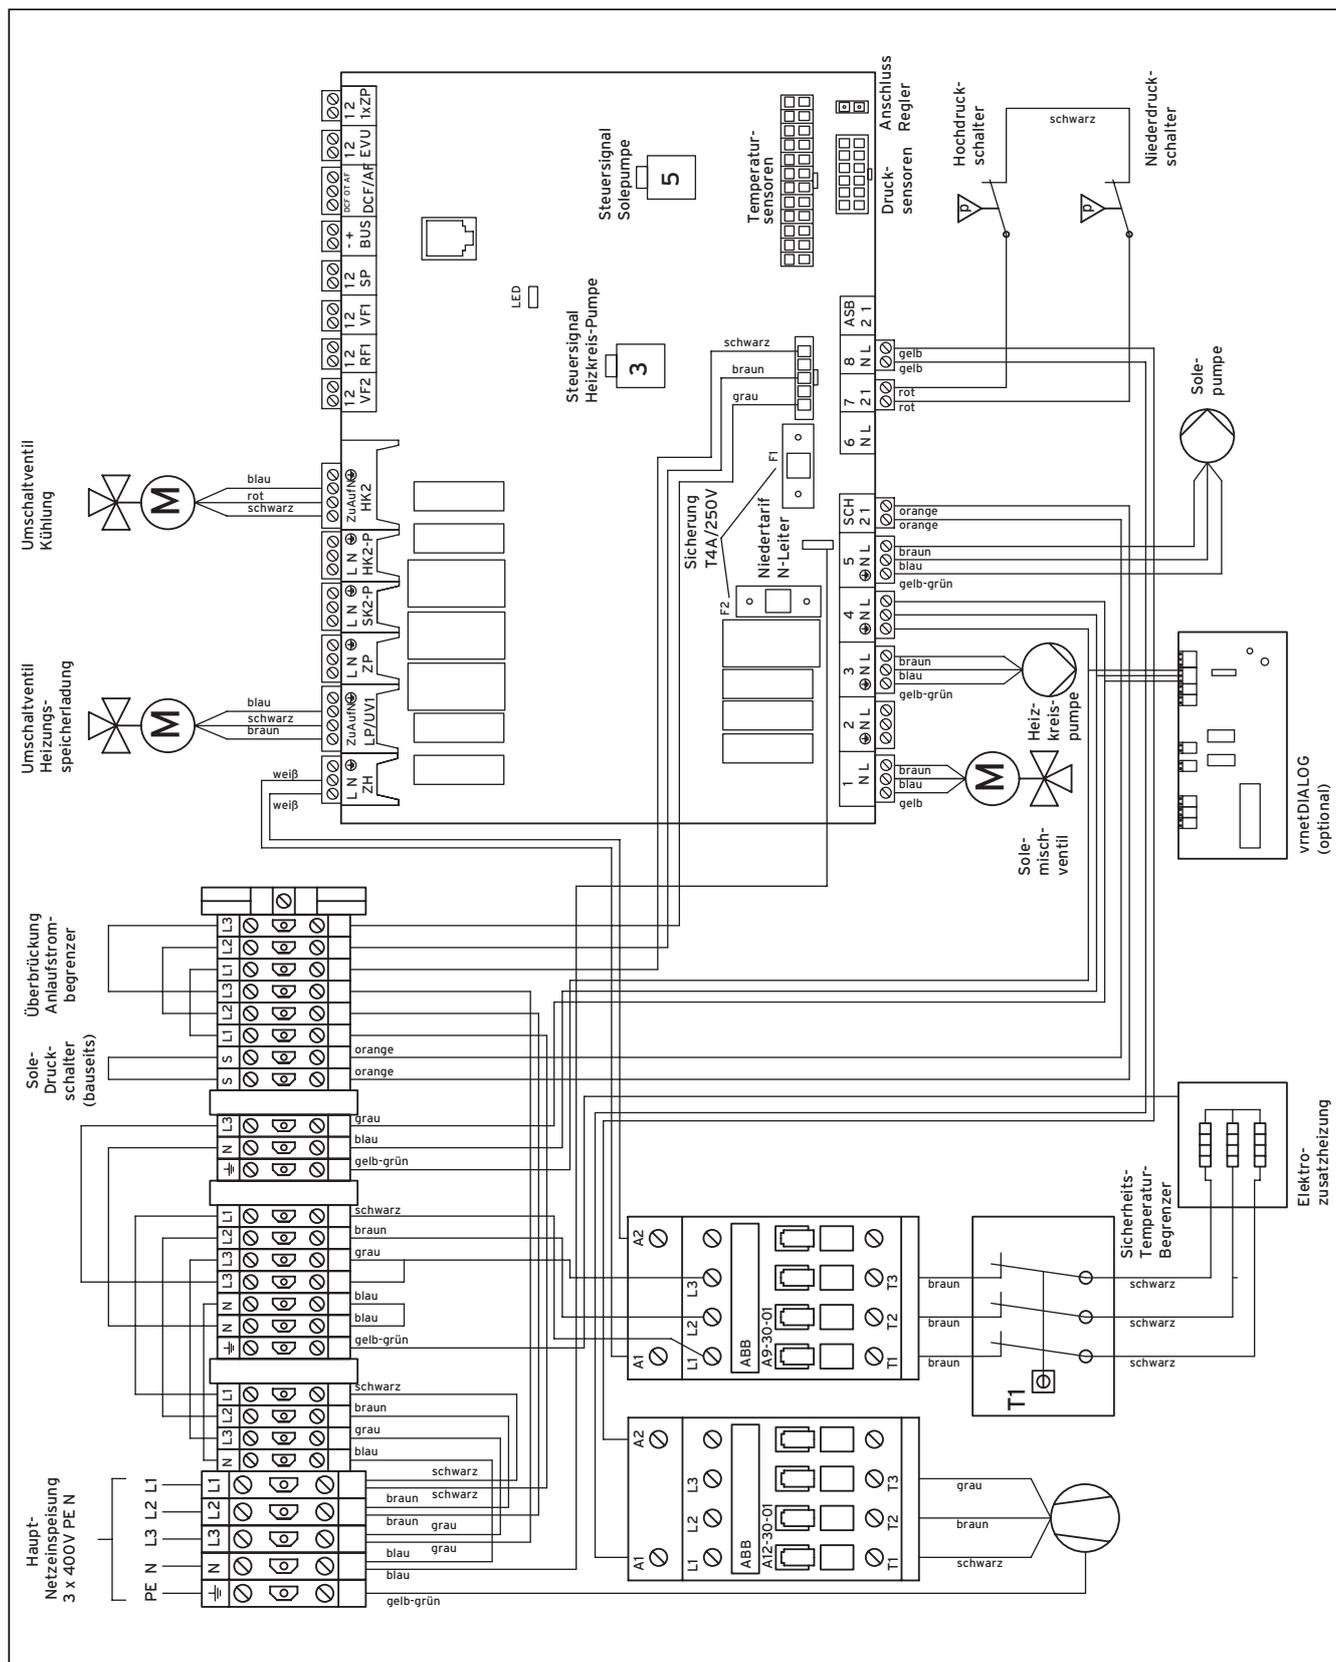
, Anhang, Stromlaufplan VWS mit integriertem Warmwasser
